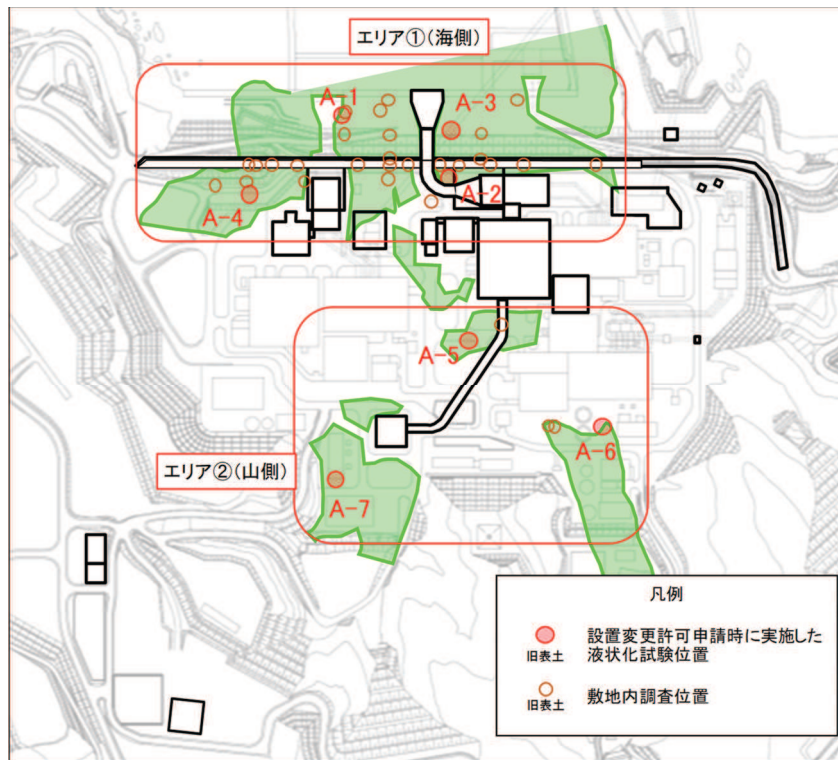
旧表土の液状化強度試験位置及び敷地内調査位置の平面図
